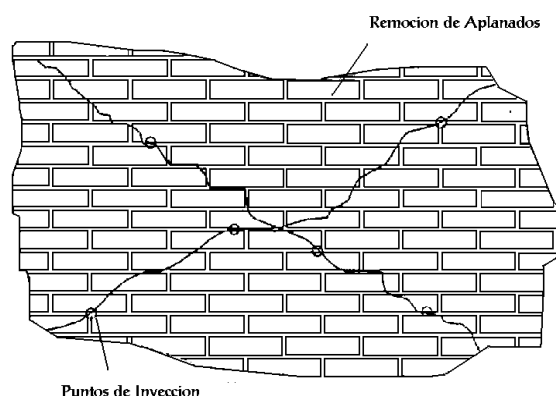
Inyección de Grietas en muros de mampostería
